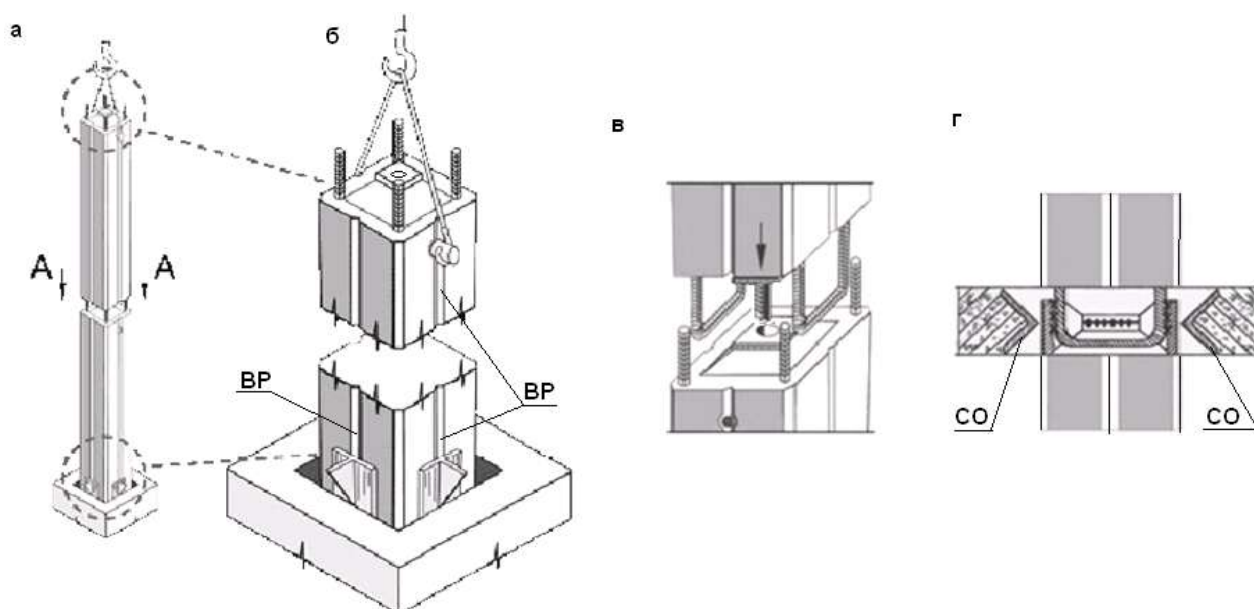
Колонны и стыки колонн безригельного каркаса «КУБ-2,5»
